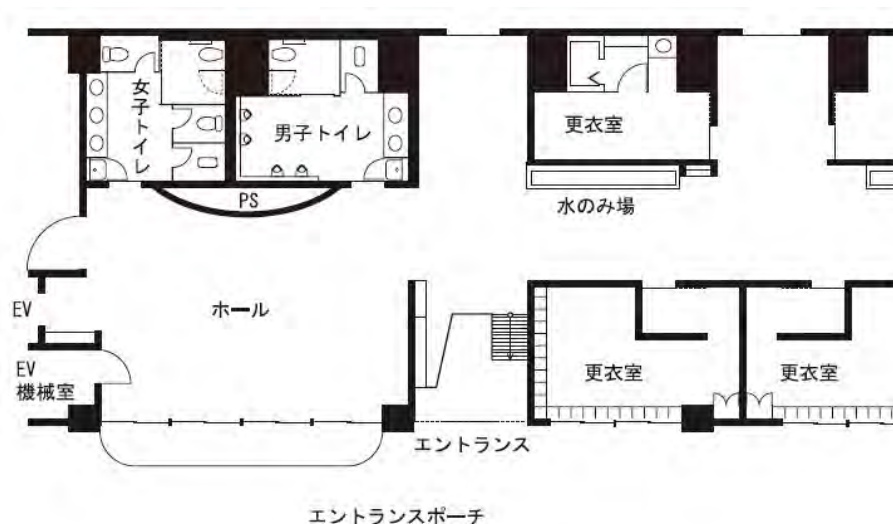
1階トイレ回り平面図（更衣室にシャワー室が設けられている）（学校のトイレ研究会誌より）
